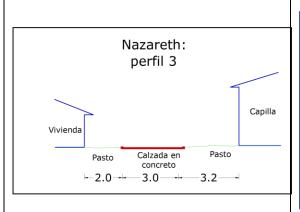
Perfil vial 3, SDP 2013. Es la continuación de las vías 1 y 2, es la vía p/pal de acceso al centro poblado. El tramo inferior hasta la capilla de encuentra terminada en concreto, y la parte restante en asfalto de reciente cobertura
